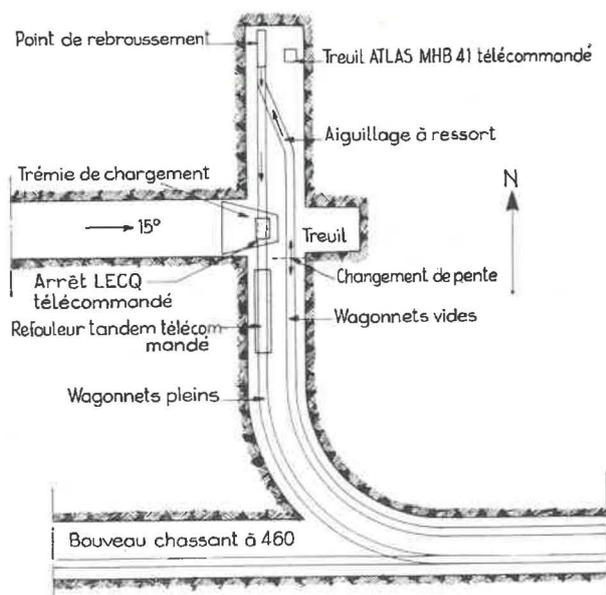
Chargement par scraper-houe en bouveau montant. Schéma de l'installation de chargement.
